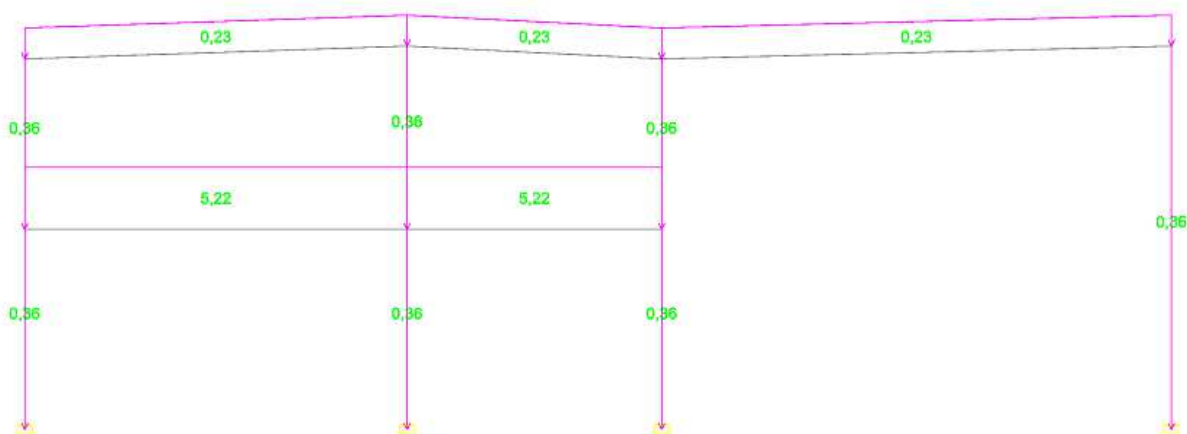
Постоянные нагрузки на раму от веса полов, кровли и стен
